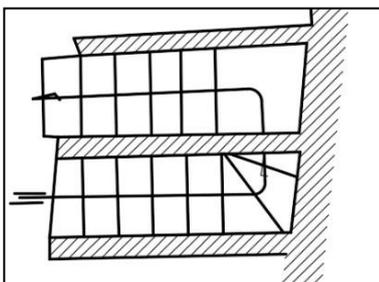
plan d'escalier. Source : plan modifié par l'auteur
